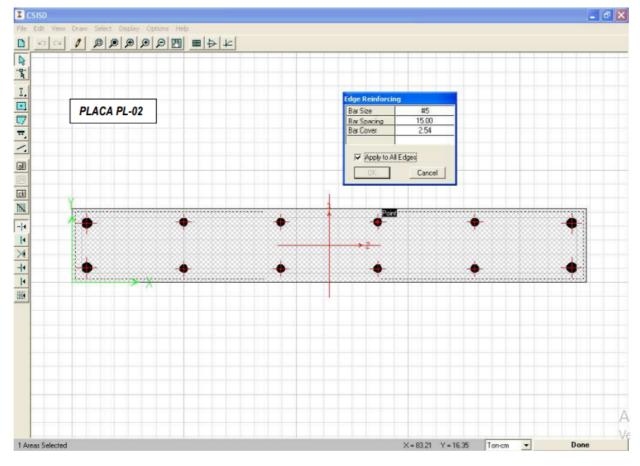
Diseño de refuero longitudinal y transversal de placas (PL-02).
